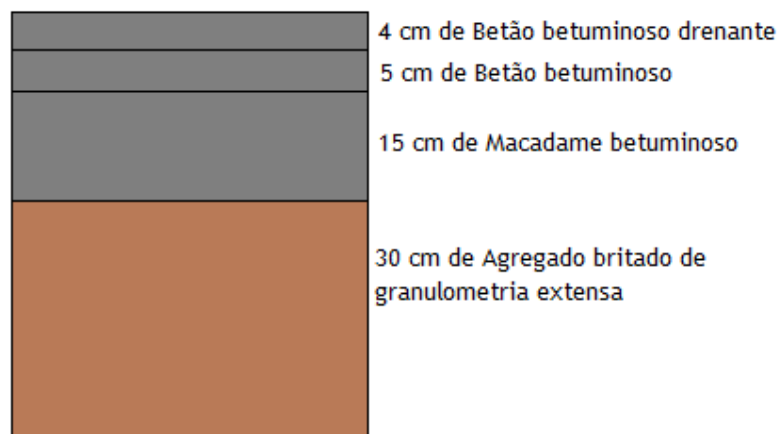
Espessura e composição de cada camada constituinte do pavimento (CE1)
